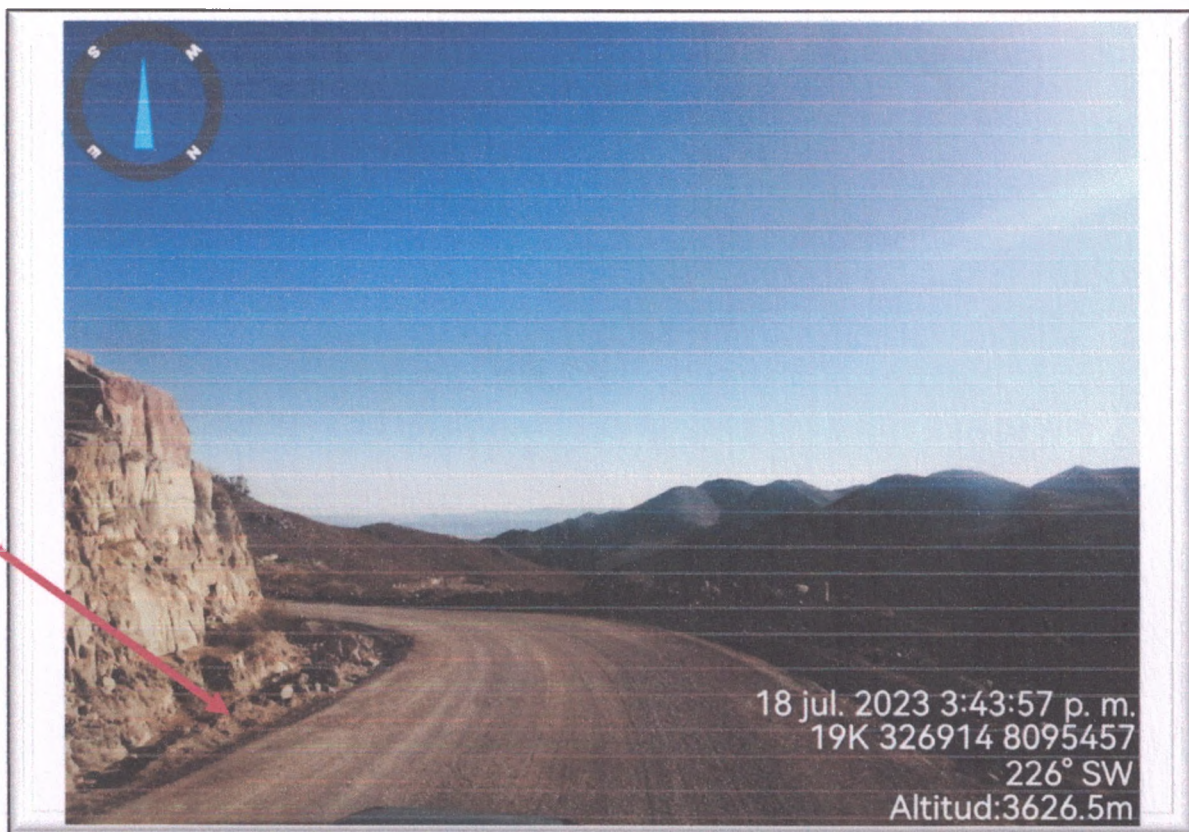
Vista de Cuneta saturada de piedras, arena y tierra en MI.
